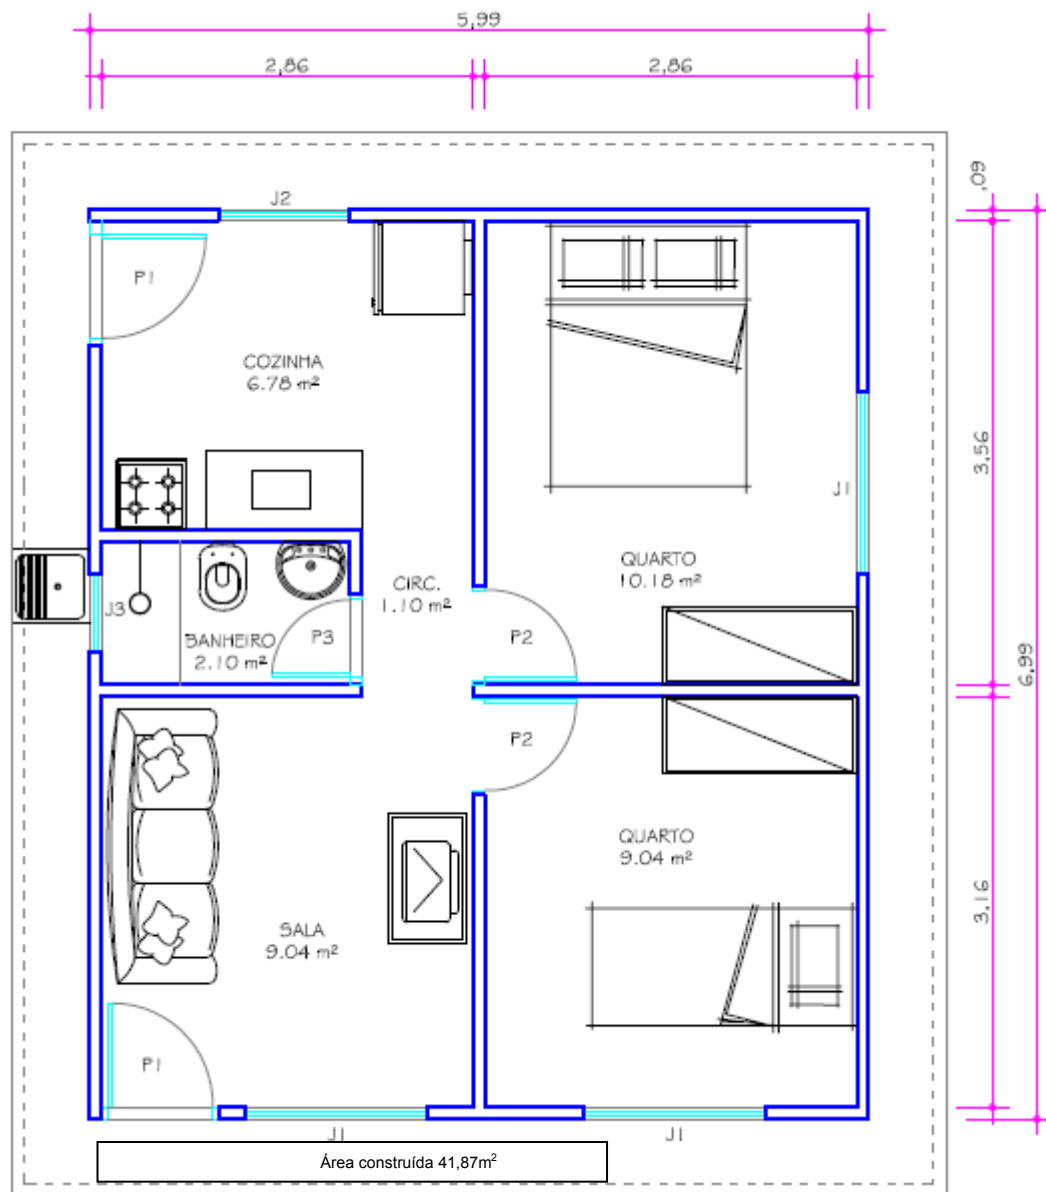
Planta baixa de projeto arquitetônico utilizado como modelo
